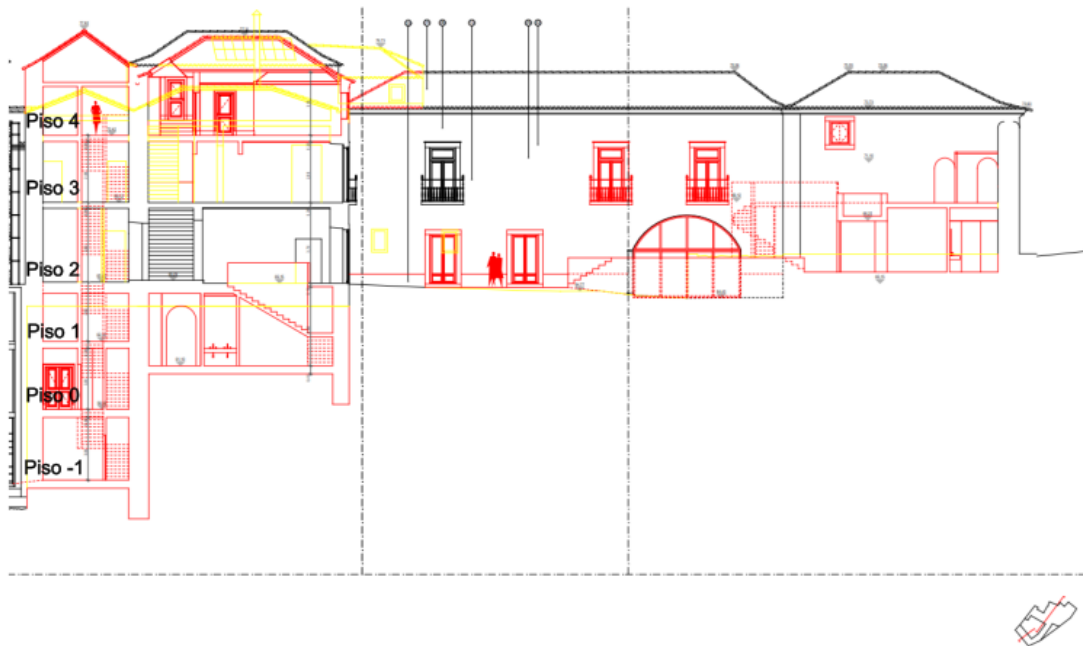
Corte projeto de alterações: zonas a demolir a amarelo e zonas a construir a vermelho.
